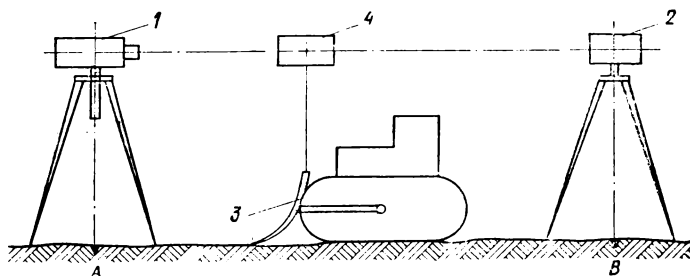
Контроль за работой землеройной машины с помощью лазера
